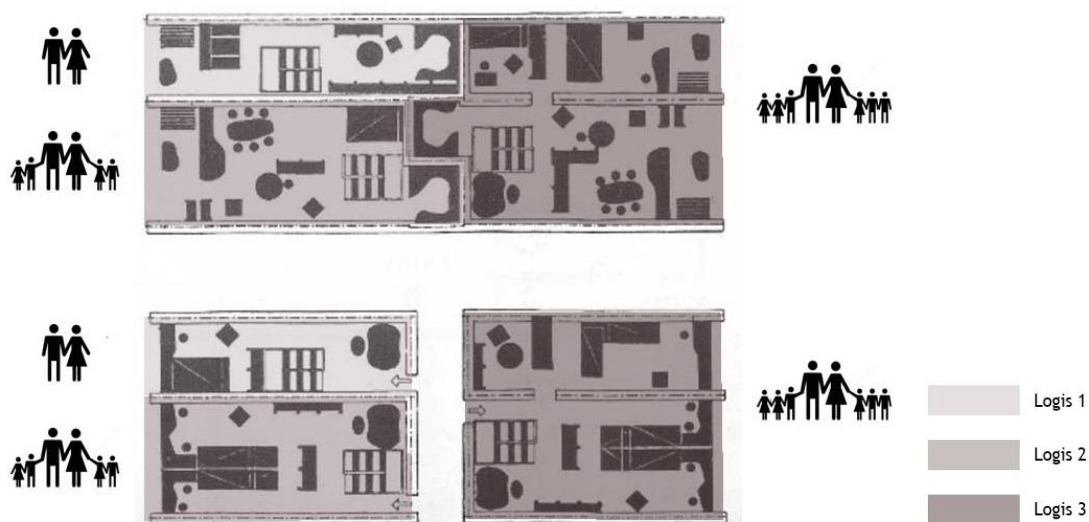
Planta Rés-do-chão (em baixo) e Planta 1º Piso (em cima) - Esquema Tipologias
